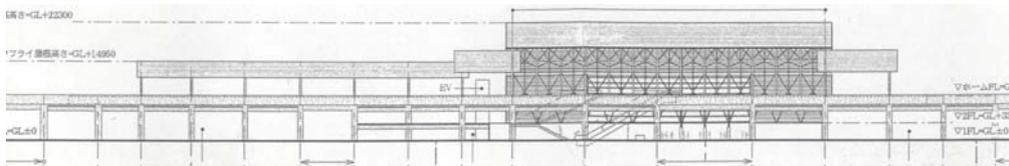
, 931 Halle et coupe longitudinale du projet de Kochi
